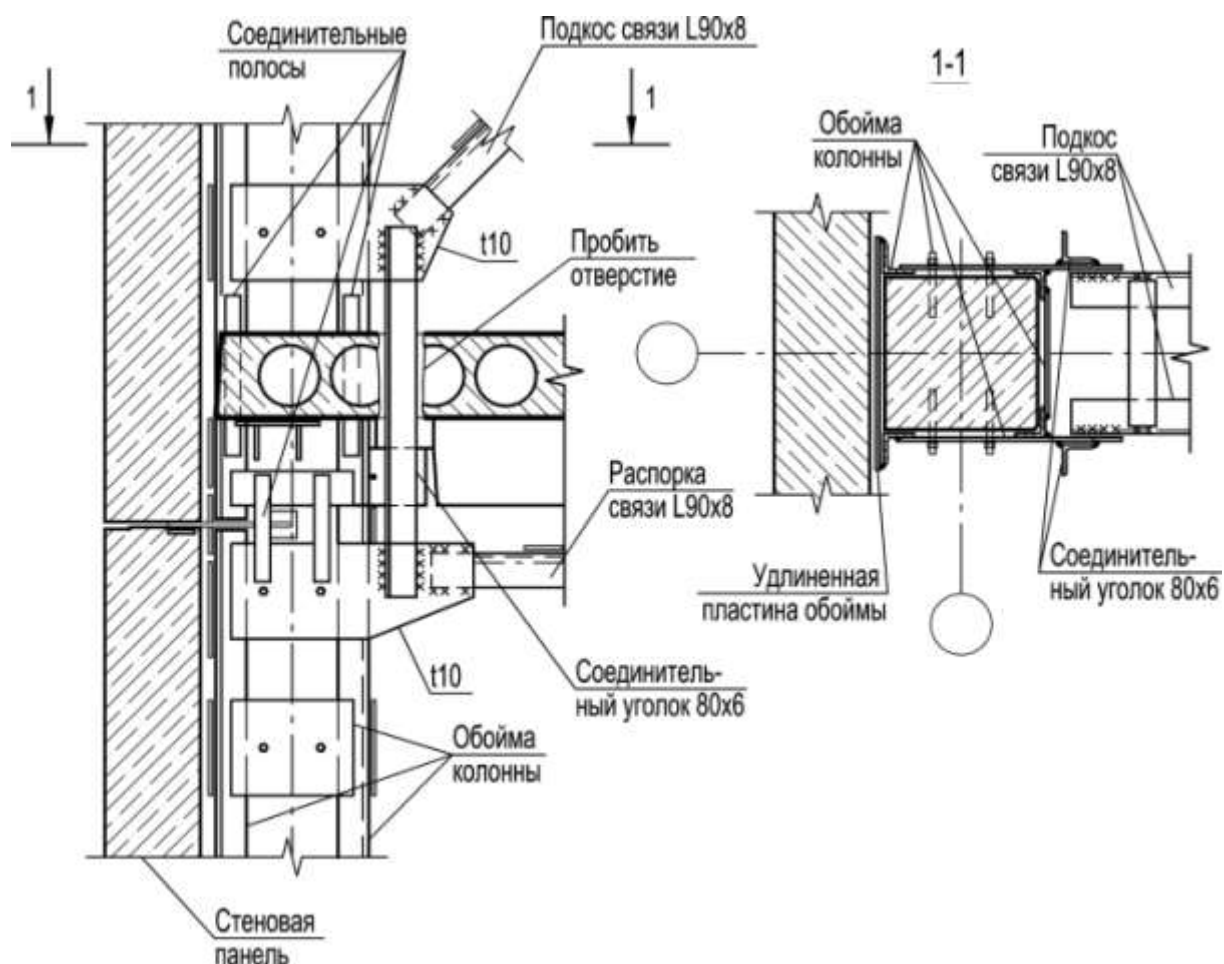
Крепление поперечных связей к колонне к стальной обойме
